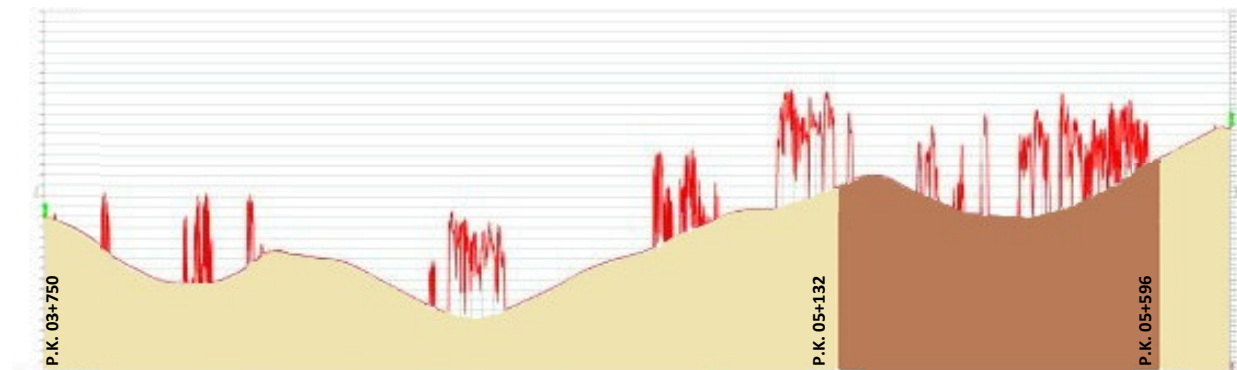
Perfil longitudinal terreno bajo el trazado de carretera con materiales por tramos.
